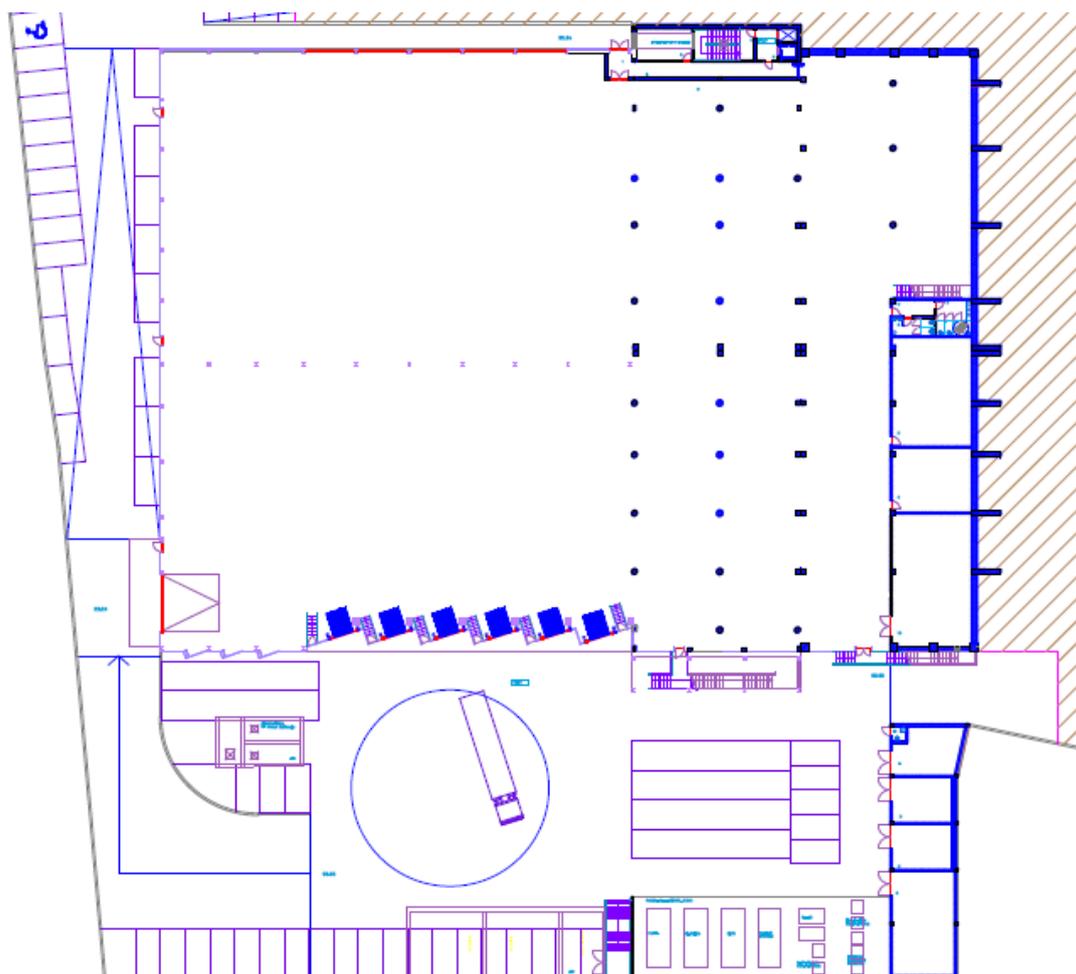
Planta do armazém, prévia à implantação das áreas e equipamentos logísticos
